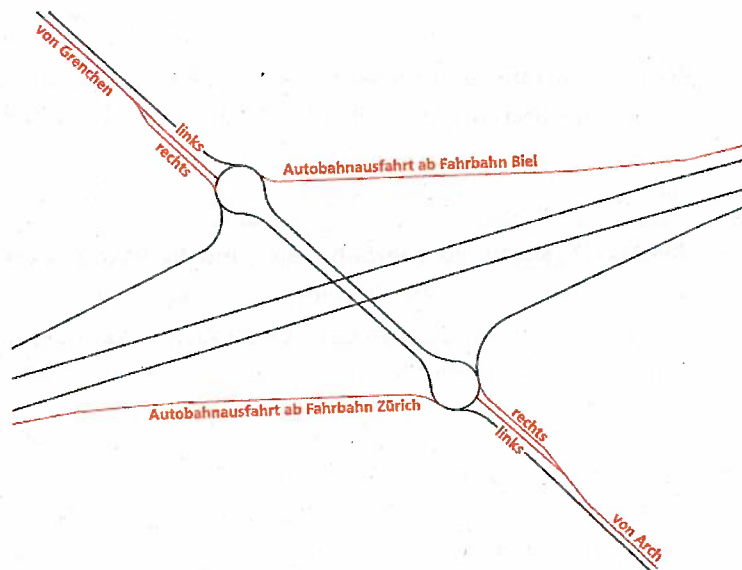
Beschriftung Zufahrten Anschluss Grenchen
